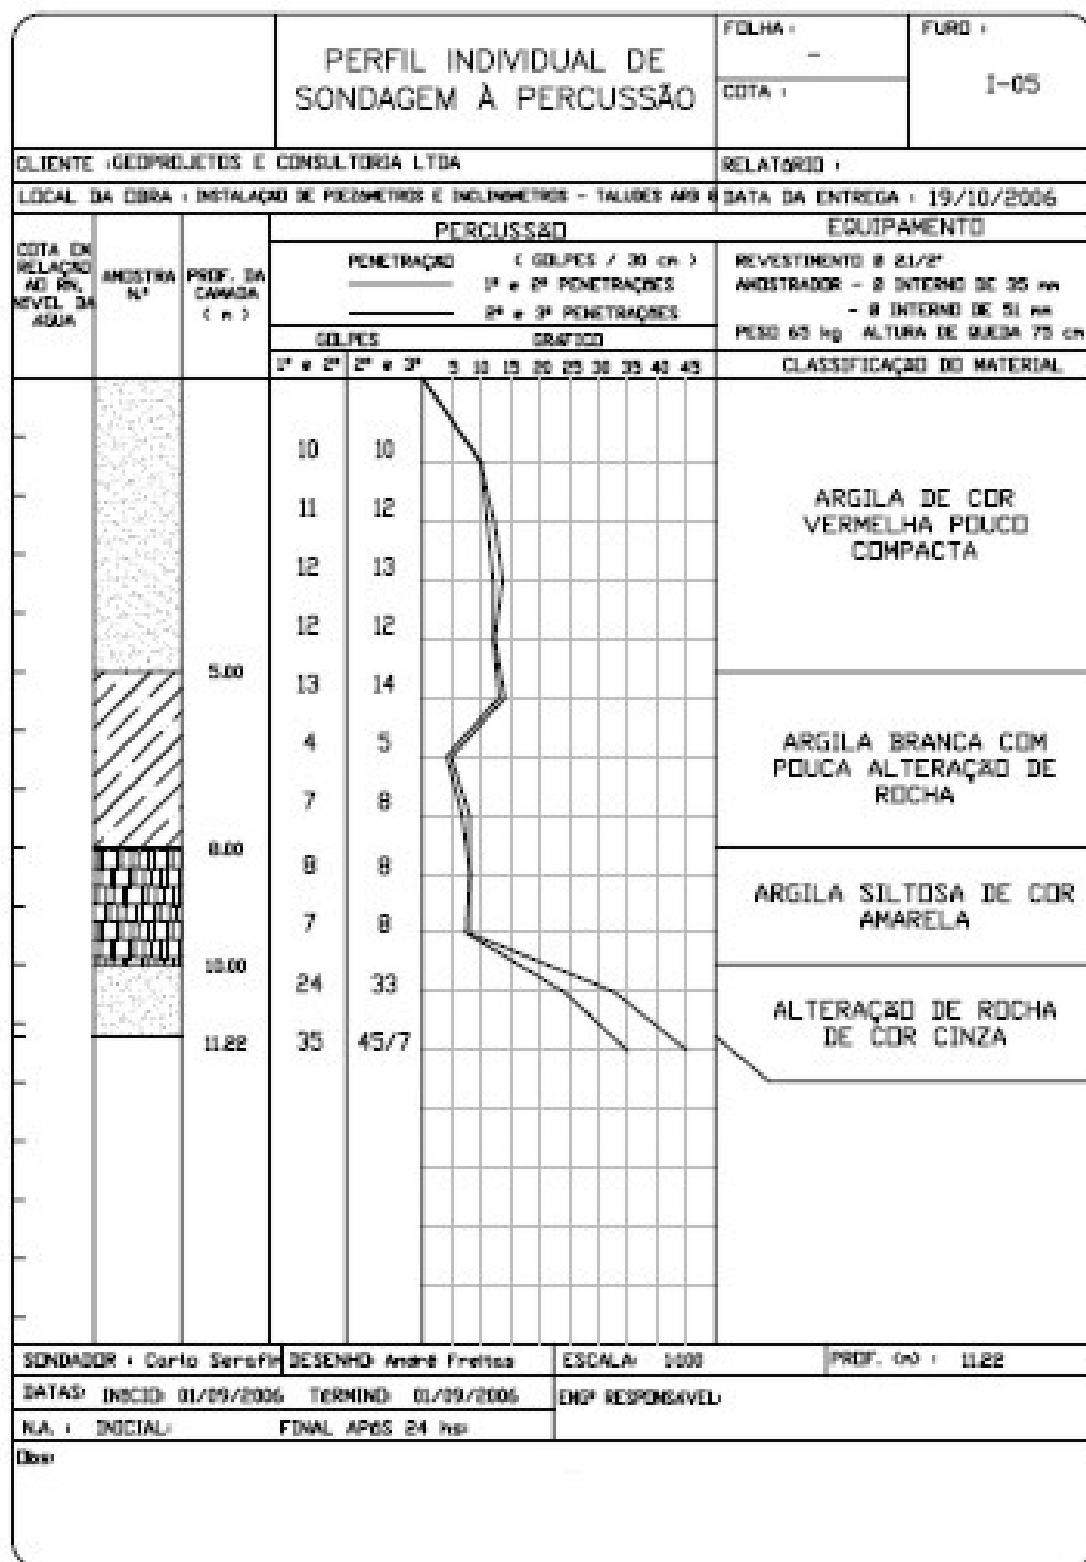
Perfil de sondagem do furo do inclinômetro I-5.
